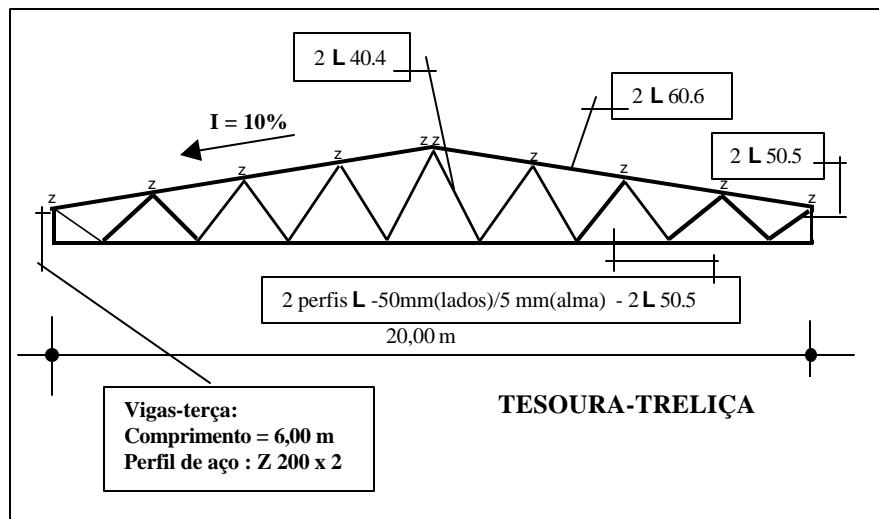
esquema do sistema estrutural com perfis de aço laminado.
